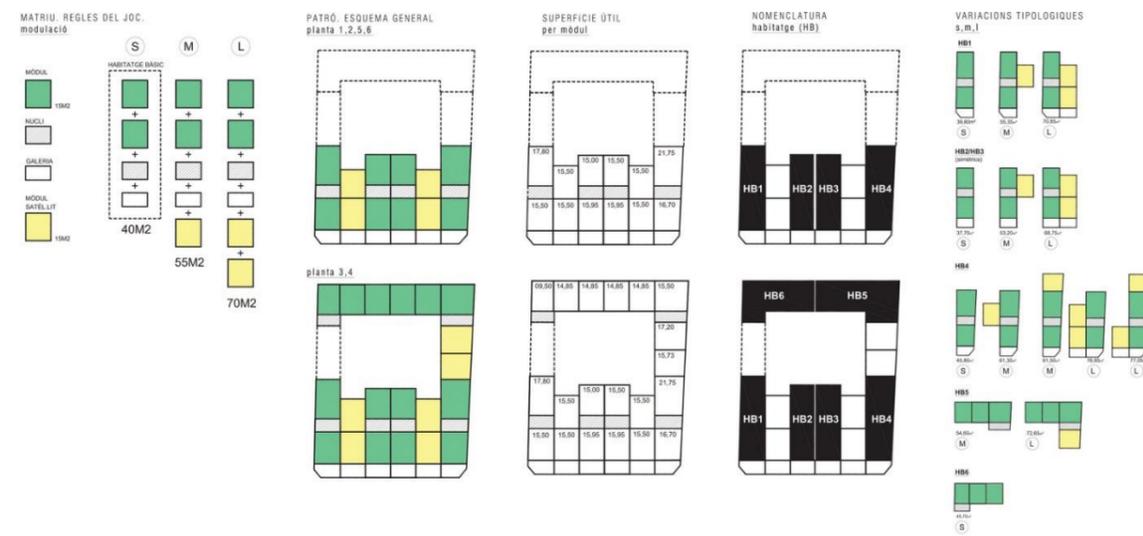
esquema de la organización por plantas y variación tipológicas en La Borda
